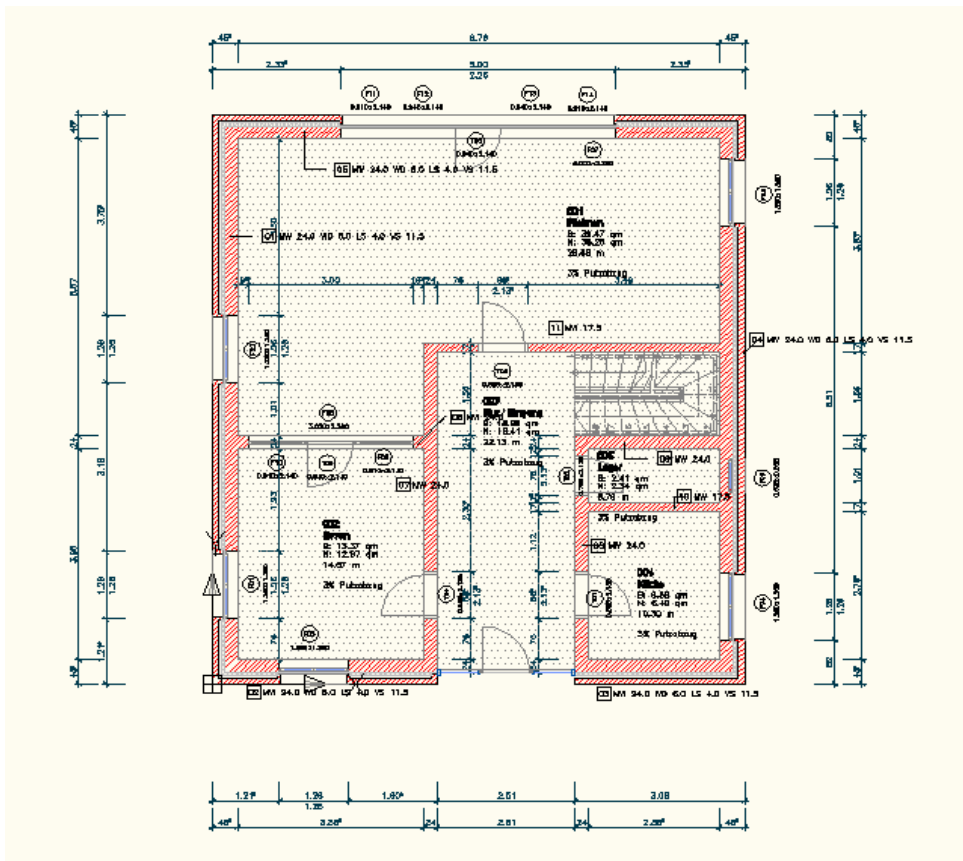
Beispielprojekt - Grundriss Erdgeschoss
